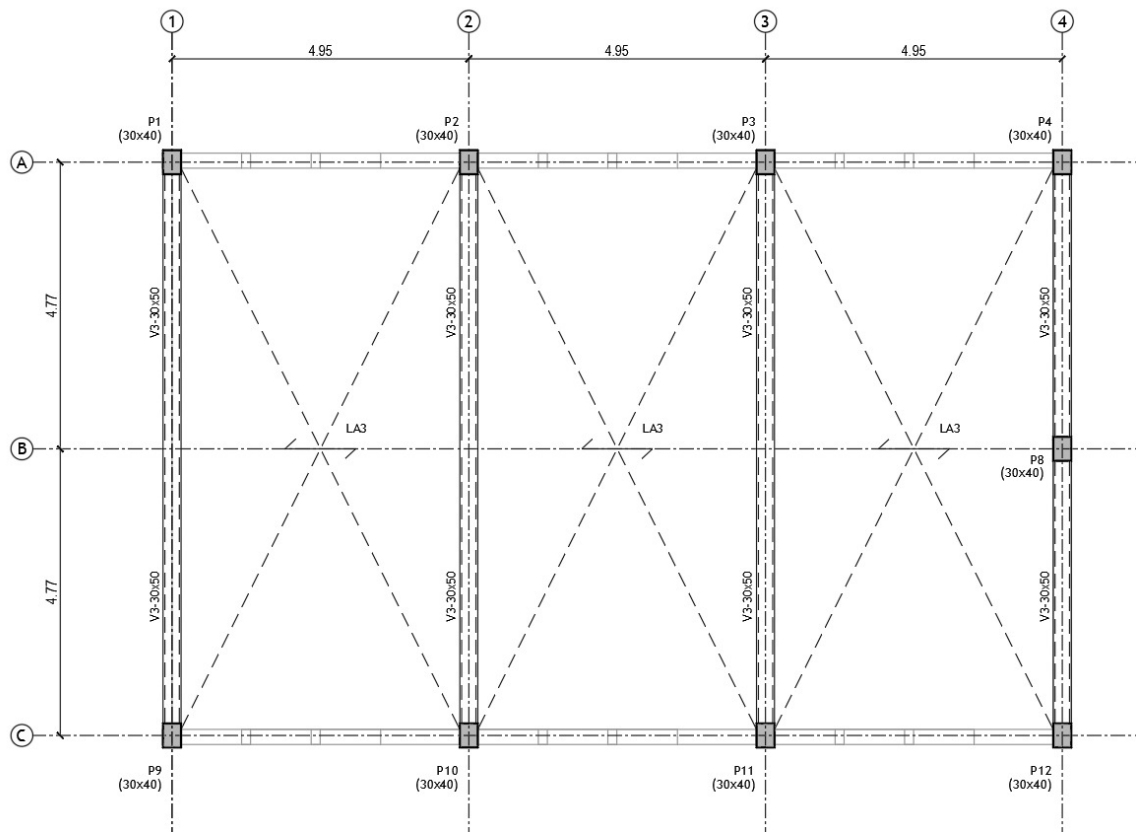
Identificação dos pilares e vigas e da orientação das lajes na cobertura
